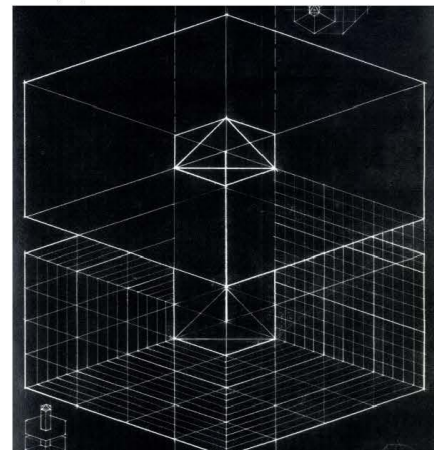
Axonometría - Planta 4D Tower. Buckminster Fuller, R., 1928
